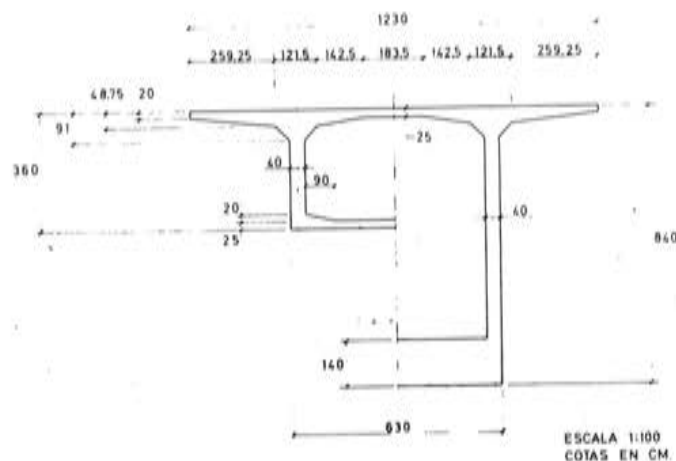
Semisecciones transversales en clave y en apoyos sobre pilas.
